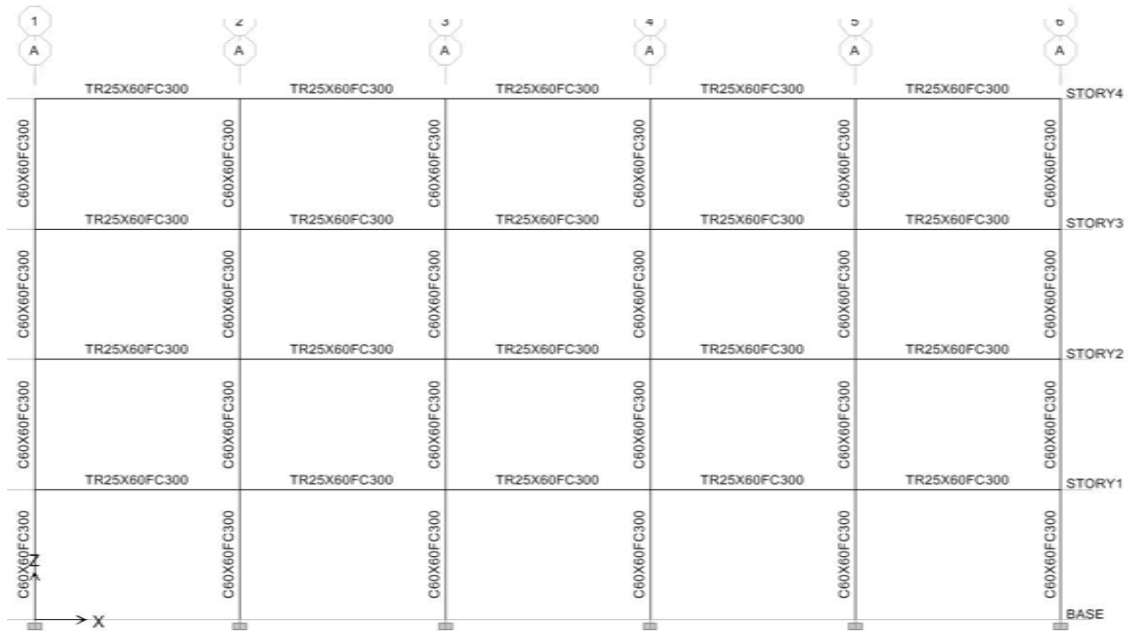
Elevación Marco Longitudinal-Planta Tipo Bloque 5 Habitaciones Modulo Recto.
